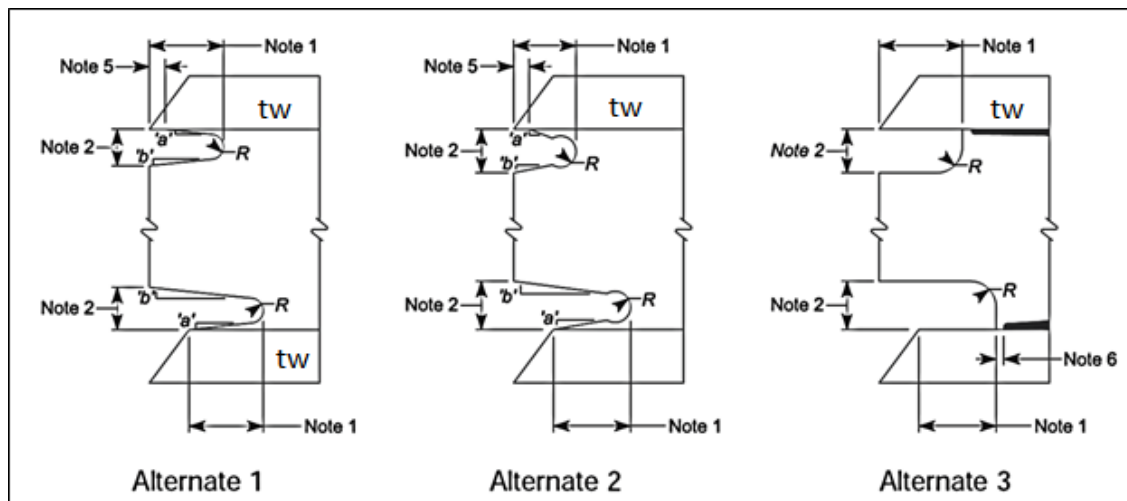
Geometría de agujero de acceso a soldadura.
